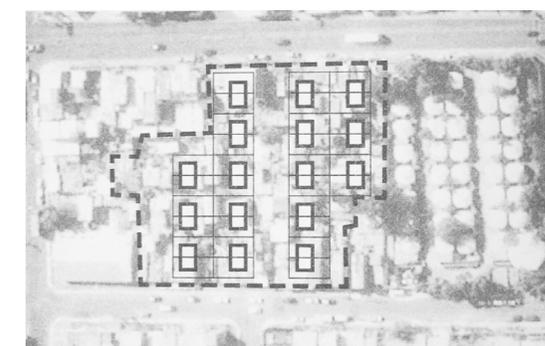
Sobreposição do loteamento da casa isolada com o bairro.
